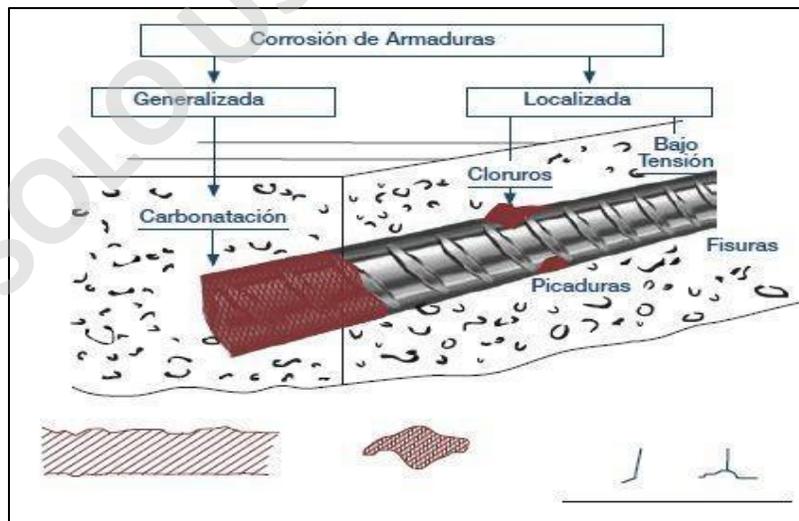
Tipos de corrosión en el hormigón armado.
